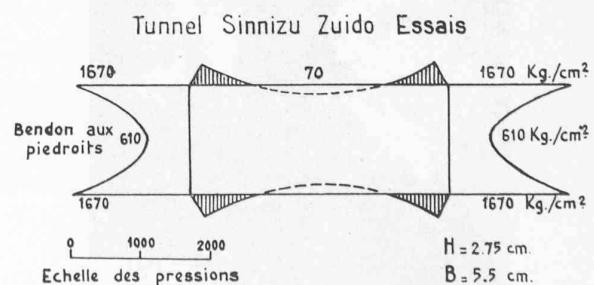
Concentration des pressions sur les parois d'une galerie rectangulaire d'après un essai sur modèle exécuté par Yamaguti.
